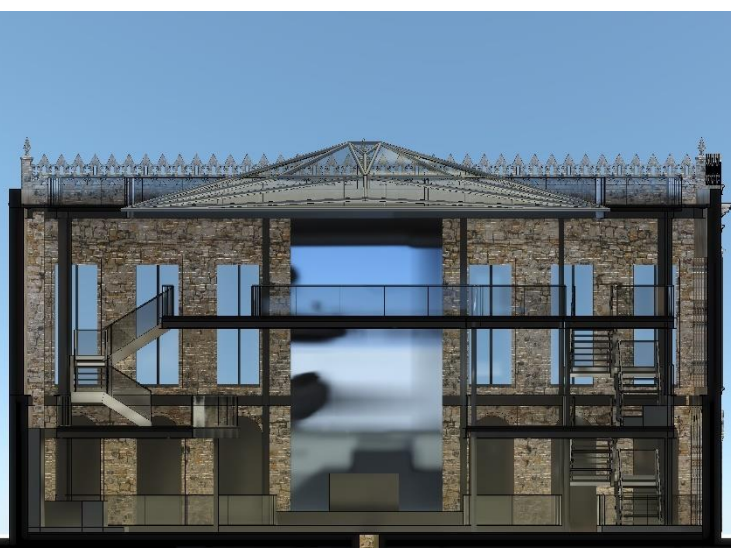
Corte Esquemático do Projeto, Fonte: Autoral, 2023
